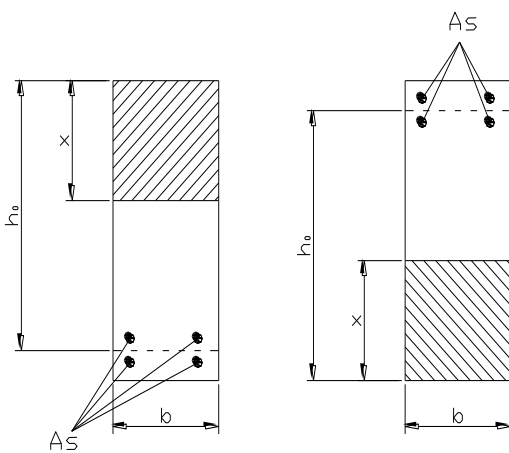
К расчету прочности ригеля – сечение в пролете (а) на опоре (б).
